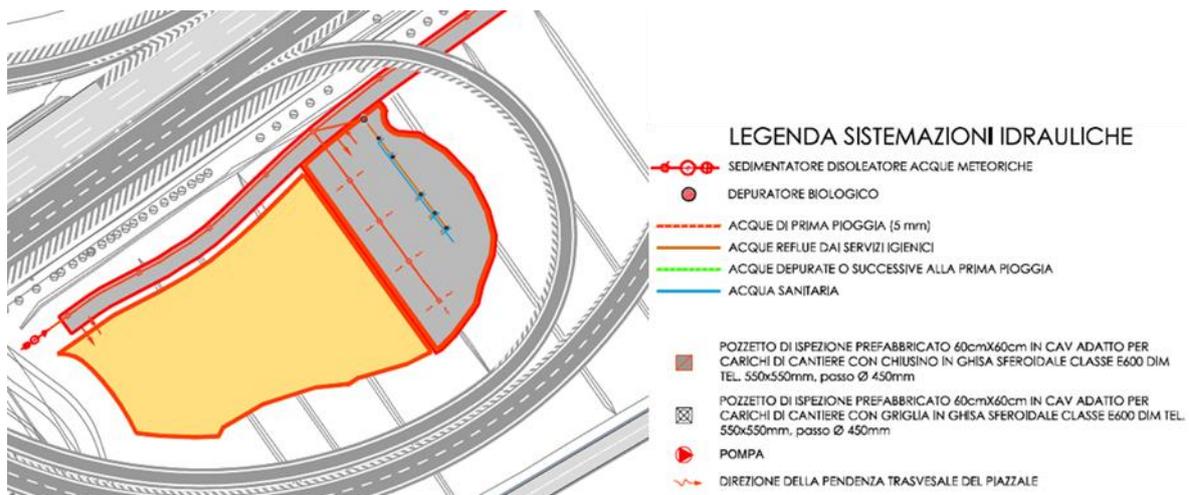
Planimetria sistema di drenaggio delle acque nel cantiere base
